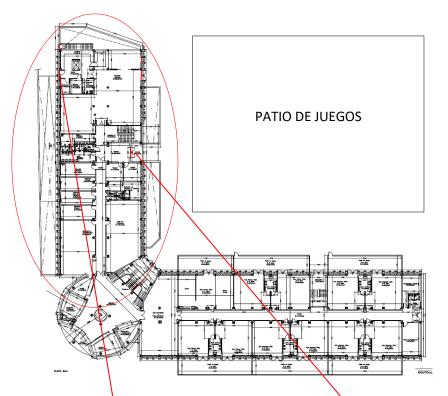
Puertas de acceso a cocina y escaleras a planta inferior, y salidas al patio de juegos
